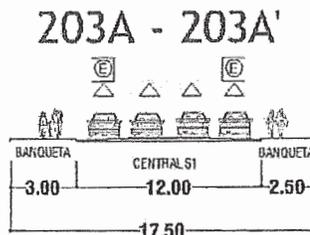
Av. Zaragoza, acceso al área de aplicación
